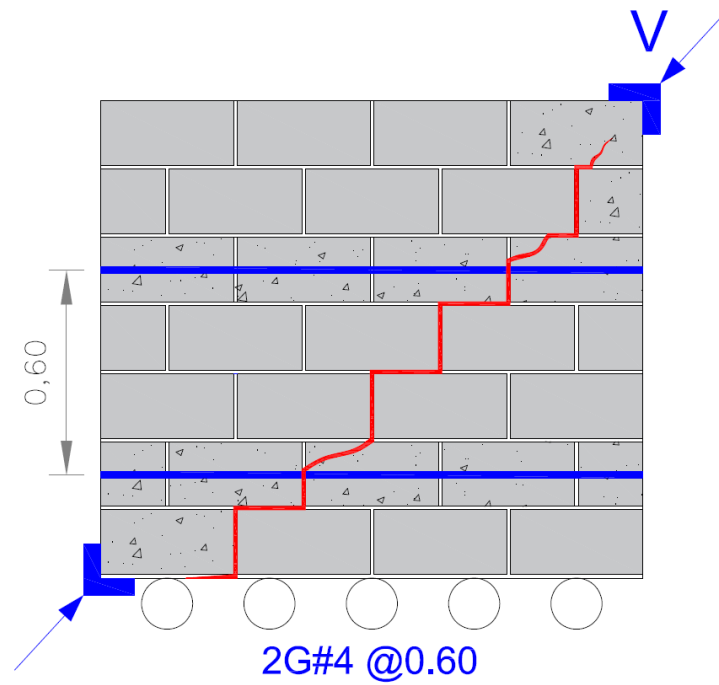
Fisuración y modo de falla del muro MD-2#4/60
